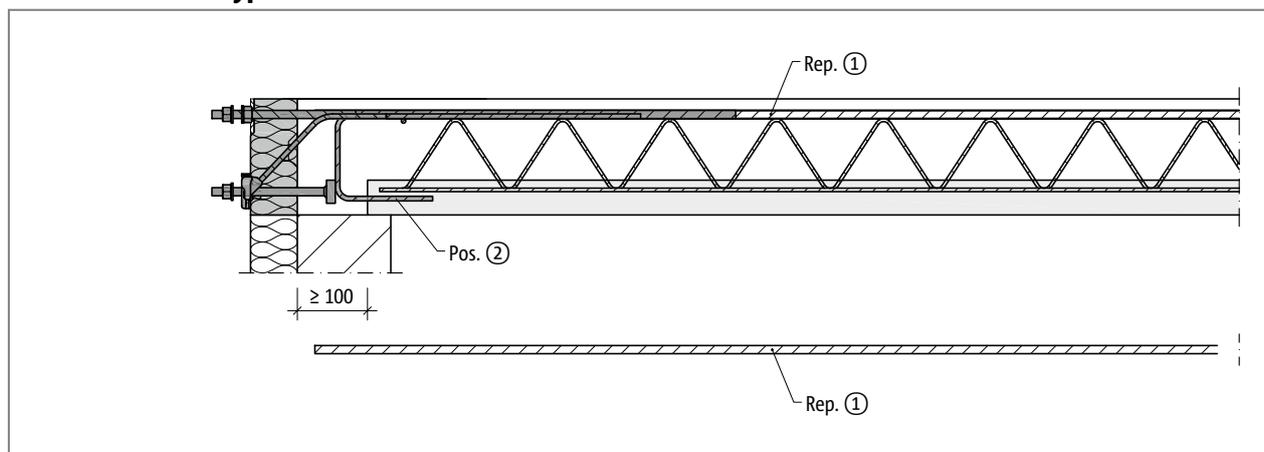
Schöck Isokorb® T type SK-M1 : renforcement sur site pour construction semi-préfabriquée, coupe
